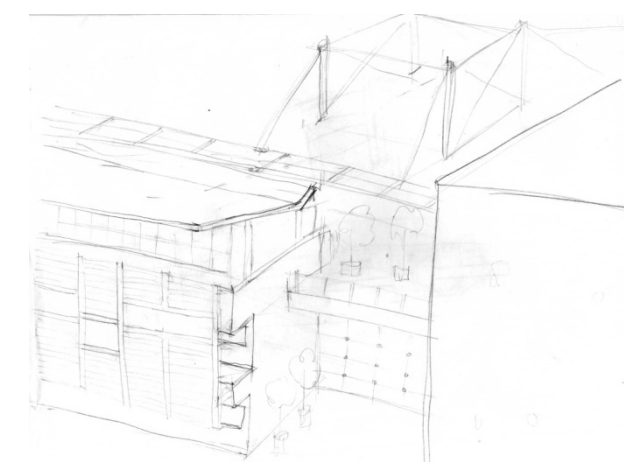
Boceto de propuesta de fachada del edificio de la División
